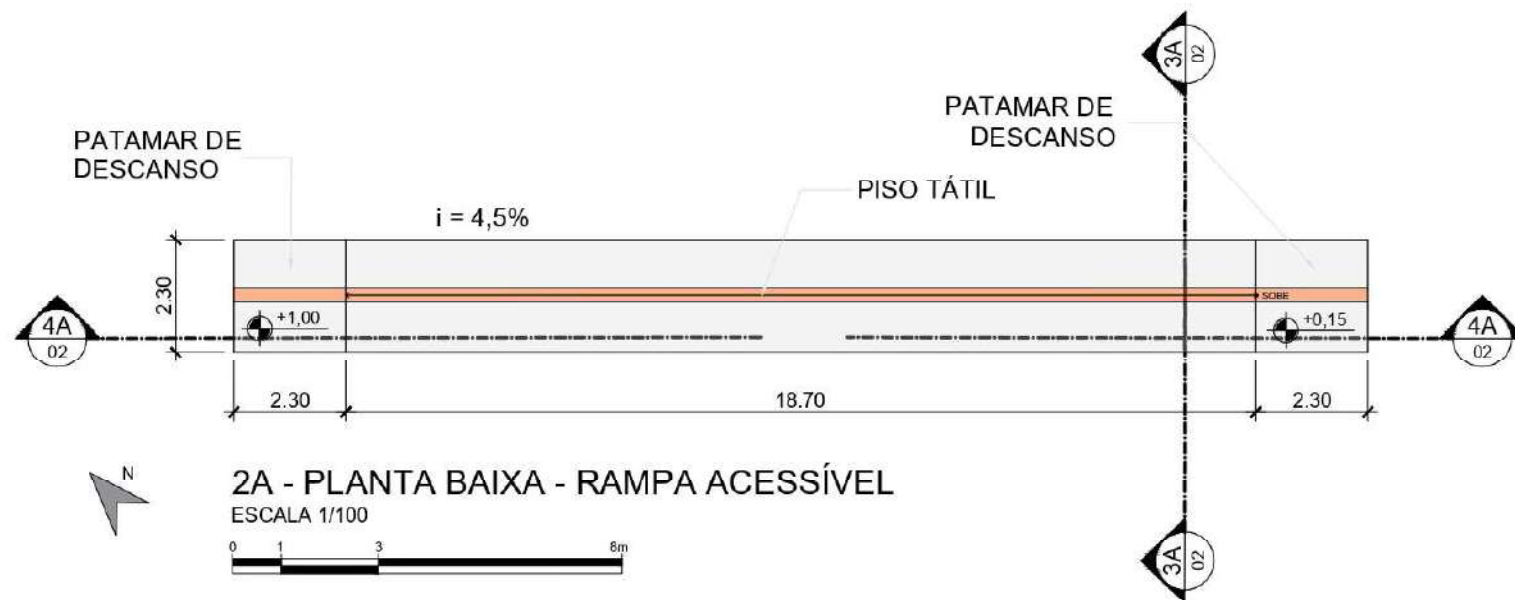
Trecho 01 – Planta Baixa -Capela Nosso Senhor dos Passos – Detalhe: Rampa Acessível. Elaboração da autora: novembro/2025.
